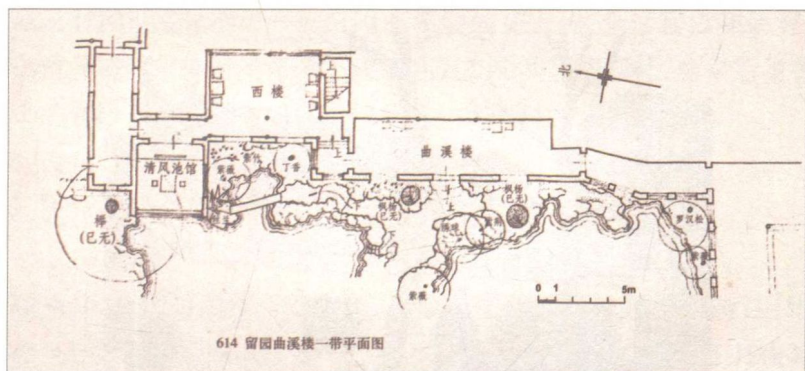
留园曲溪楼、西楼及清风池馆建筑平面图
